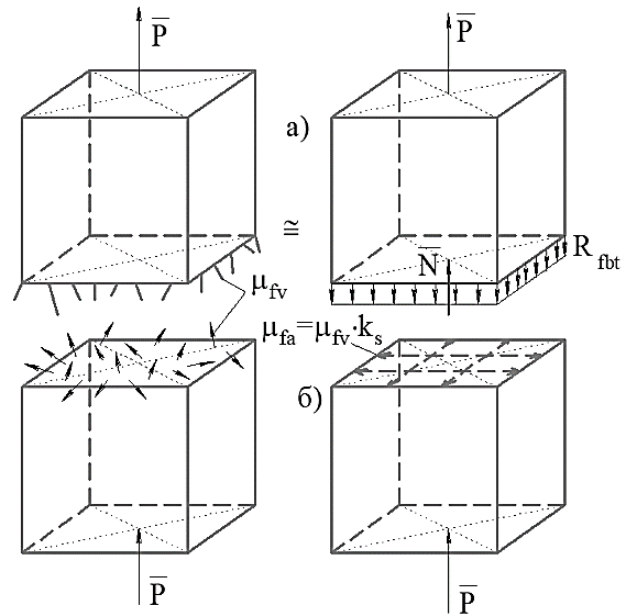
Схема усилий и эпюра напряжений при центральном сжатии сталефибробетонных элементов: а) эпюра напряжений; б) учёт коэффициента приведённого армирования
